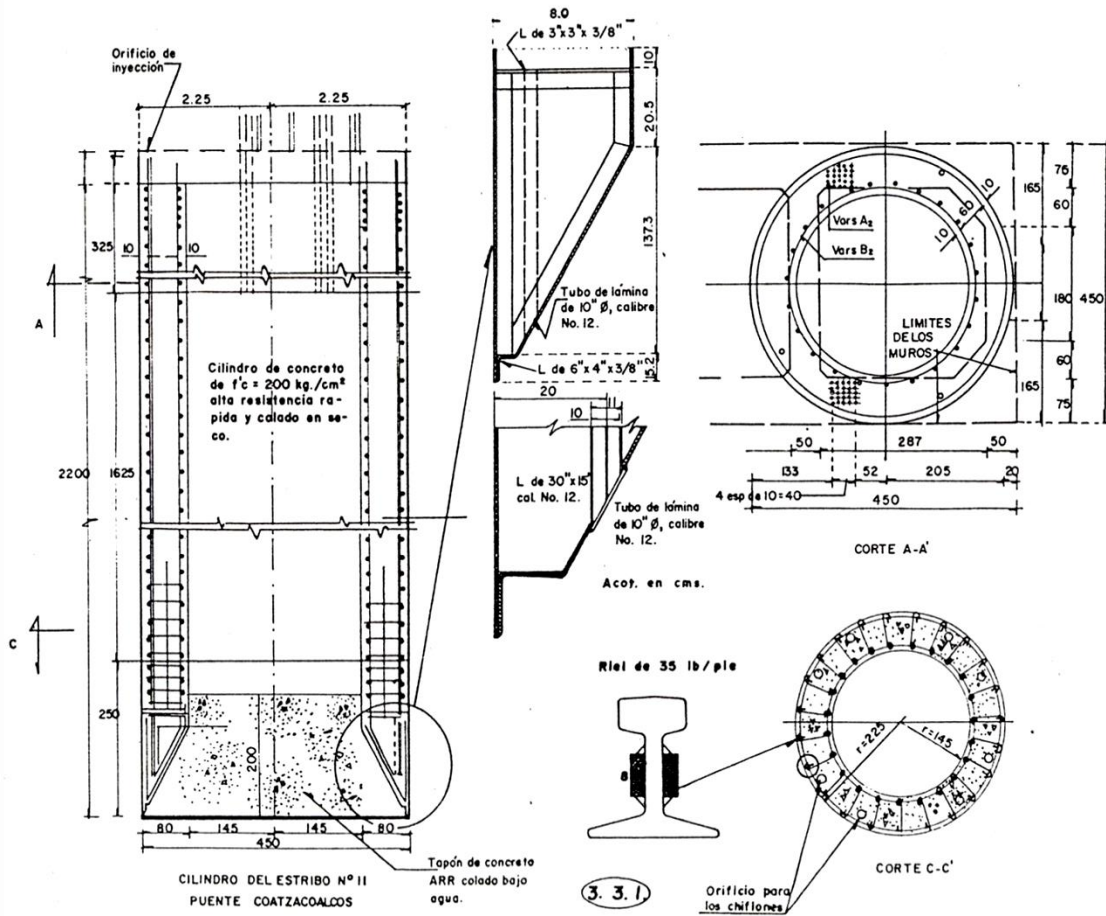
Cilindro de cimentación utilizado en apoyo 11 del puente Coatzacoalcos, México (Ketty, 2003).
